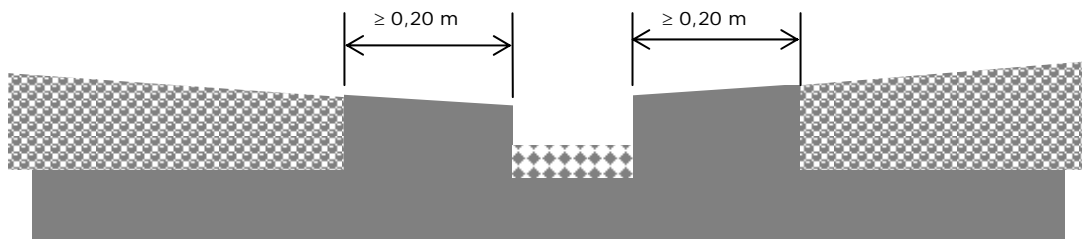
Coupe de principe de réservation sur chéneaux ou caniveaux
